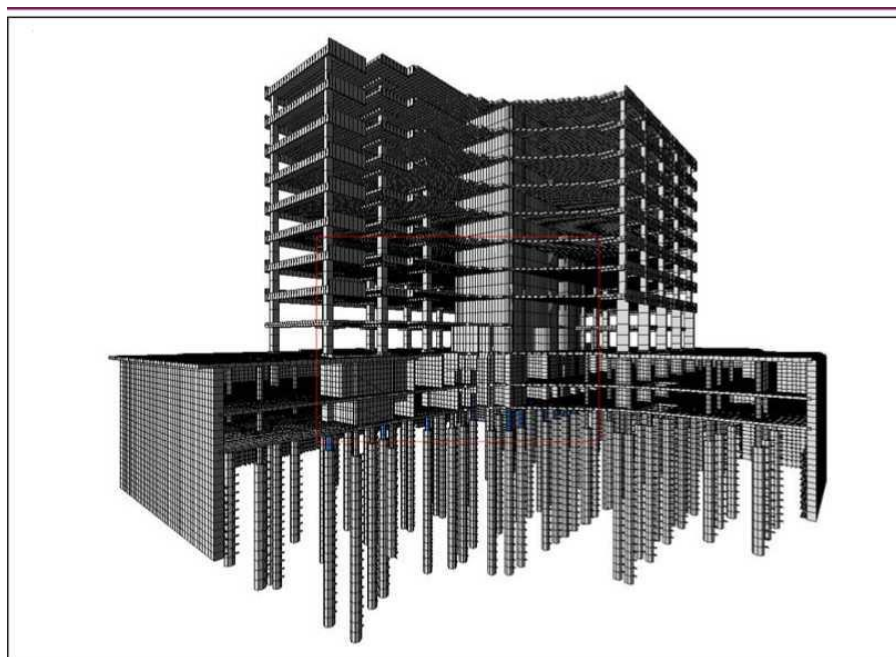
Розрахункова 3D-модель несучих конструкцій будівлі на стадії завершення екскавації ґрунту в котловані (дев'ять надземних поверхів зведені раніше фундаментної плити)
